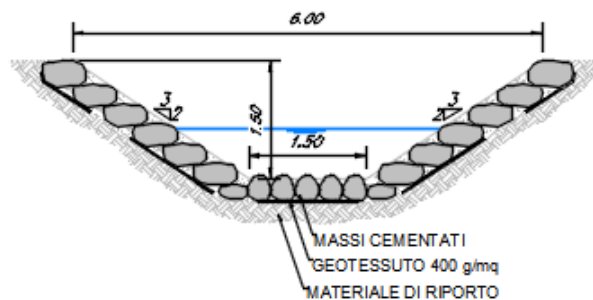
Corso d'acqua IN15_ Sezione tipo sistemazione
